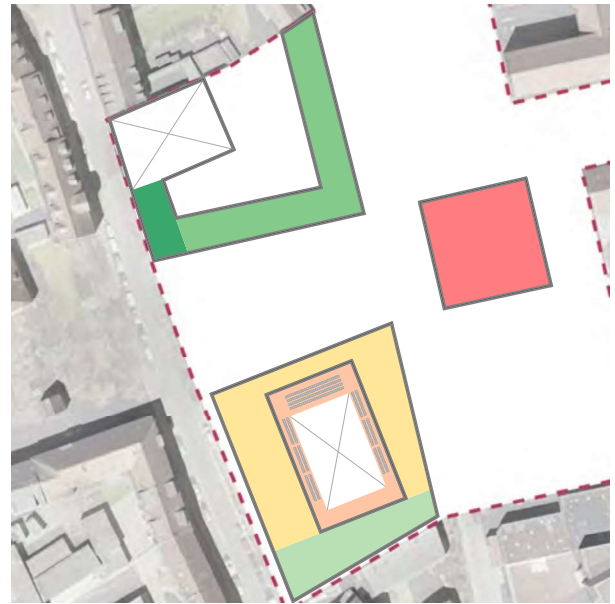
Grundriss OG1 Großer Hof V2
